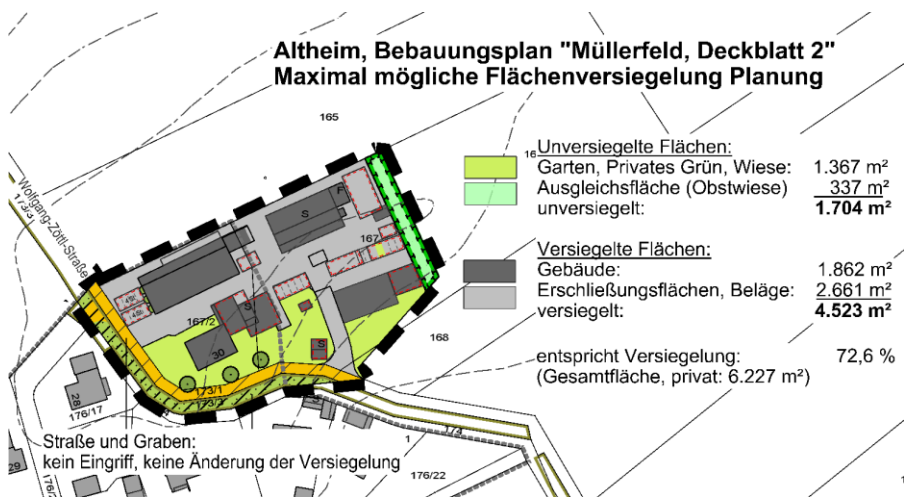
Flächenversiegelung Planung, EGL, 26.08.2024 unmaßstäblich
